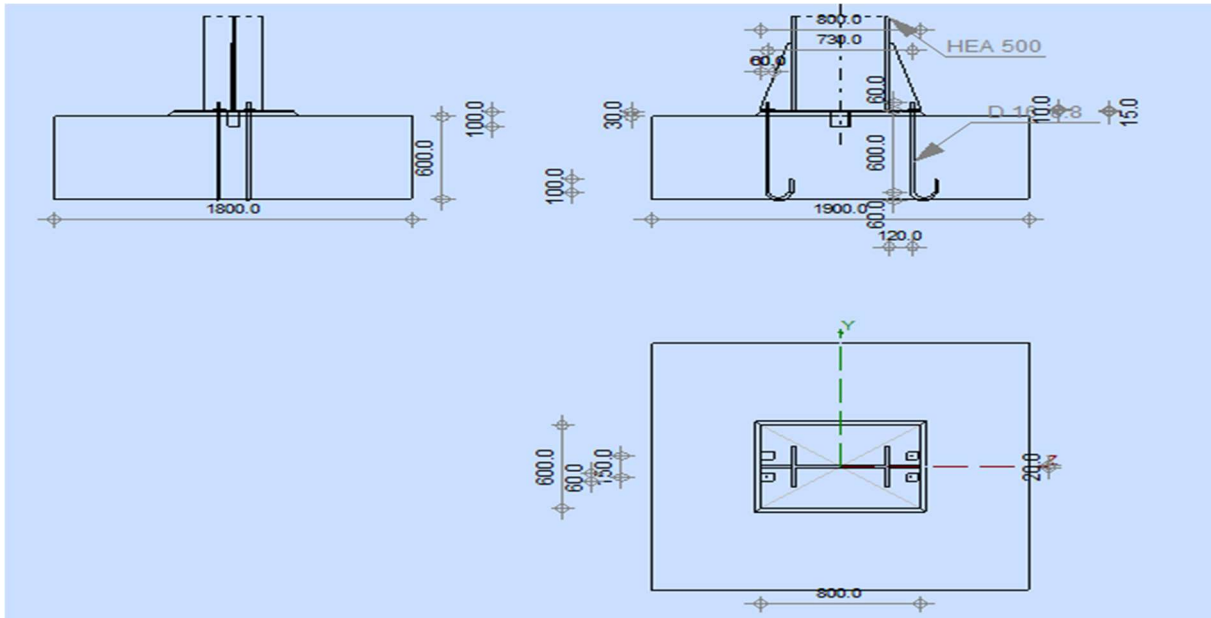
Détails sur l'assemblage pied de poteau.
